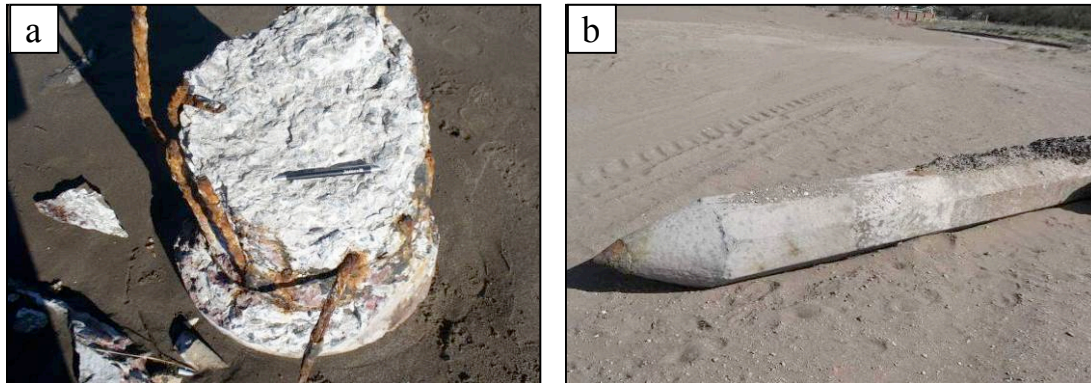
a: Fisuras en el encamisado (espigón Oeste), b: Desprendimiento del hormigón del encamisado y armaduras a la vista (espigón Oeste).
